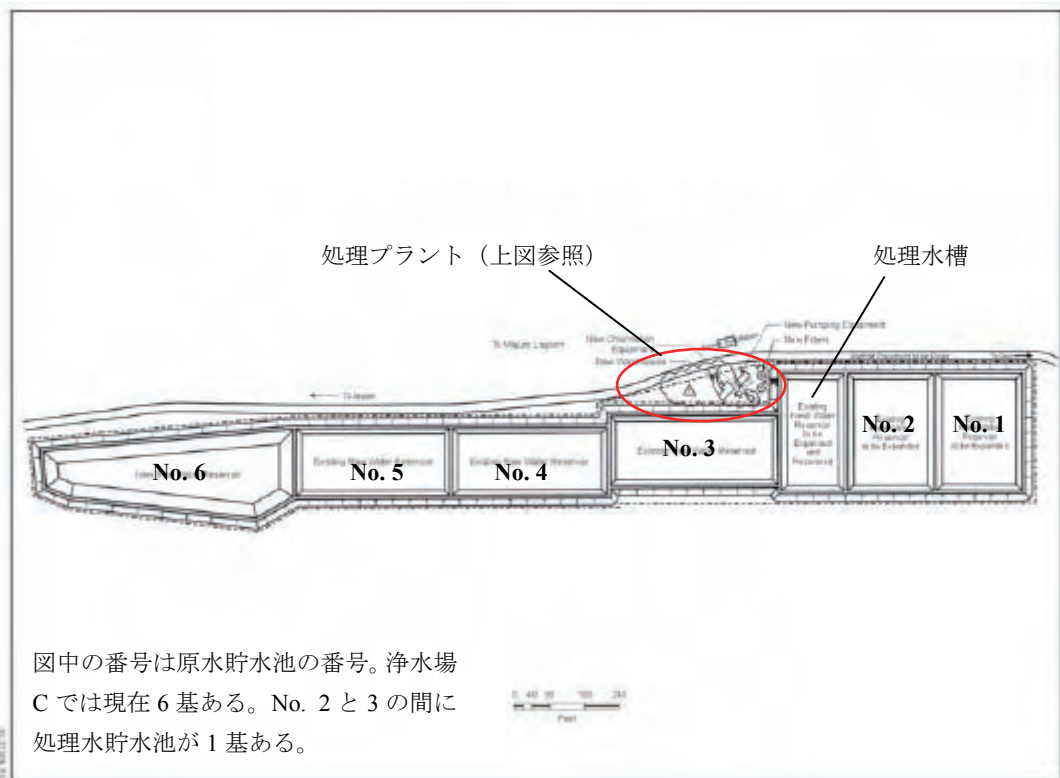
浄水場 C の原水及び処理水貯水池平面図
